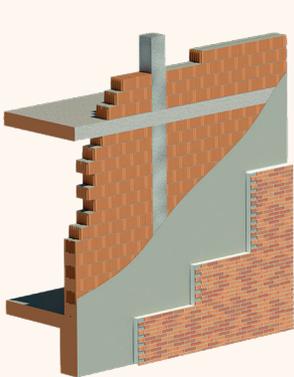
Fachada con hoja principal cerámica con un sistema prefabricado de aislamiento térmico por el exterior con acabado de plaqueta cerámica vista
